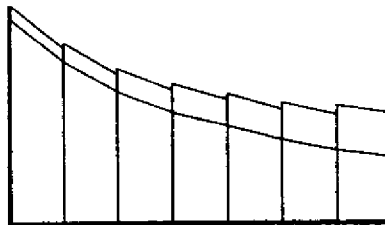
21: Perfil longitudinal de una alcantarilla
